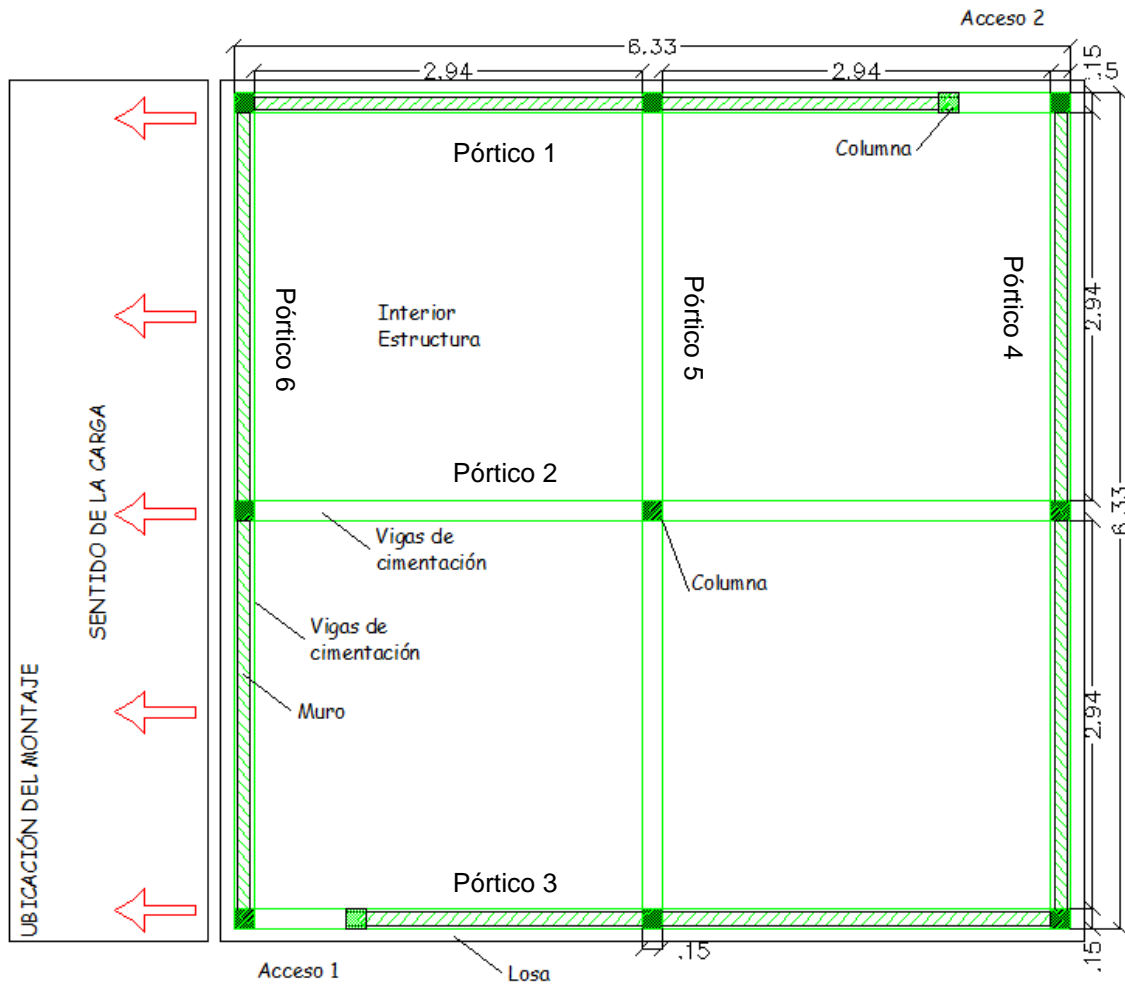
Planta estructural de estructura a escala real, sentido de carga y ubicación de pórticos. Fuente: Autor.
